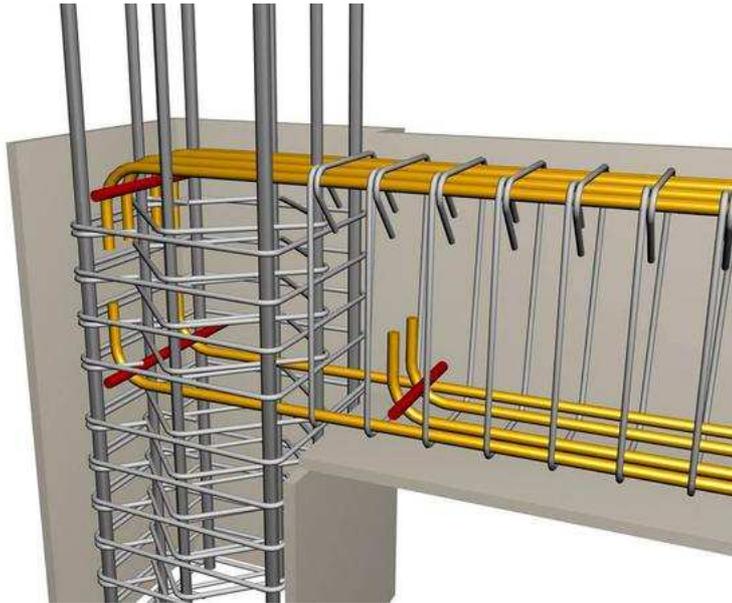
Conexión Viga-Columna (BIBLIOCAD, 2011)
